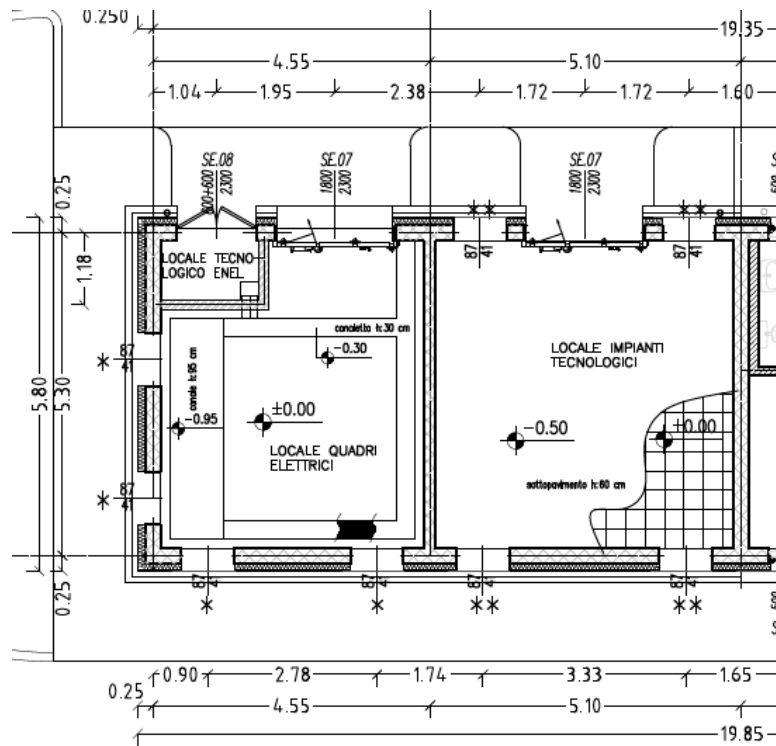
Pianta della porzione di edificio destinata a fabbricato impianti.
